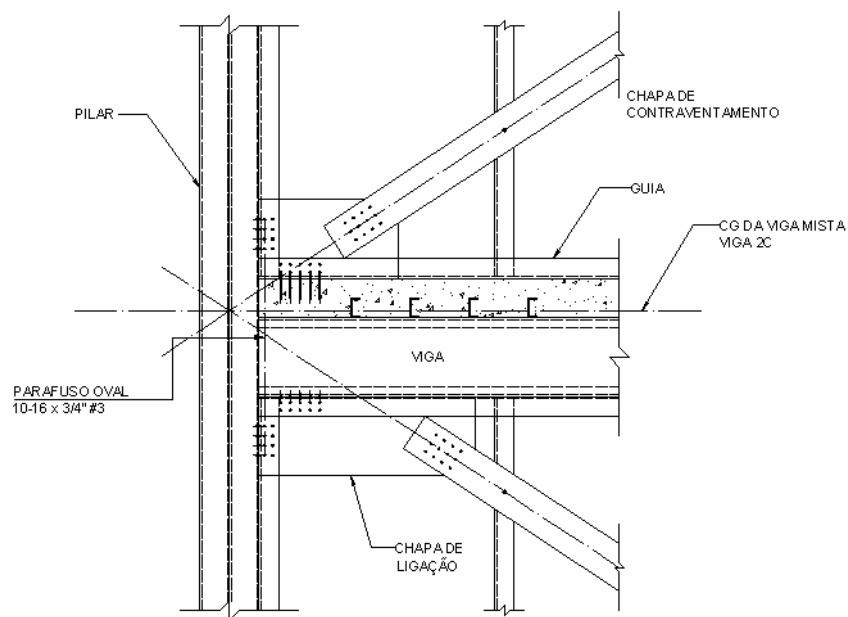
Detalhe construtivo da ligação Contraventamento inclinado – estrutura [3]
